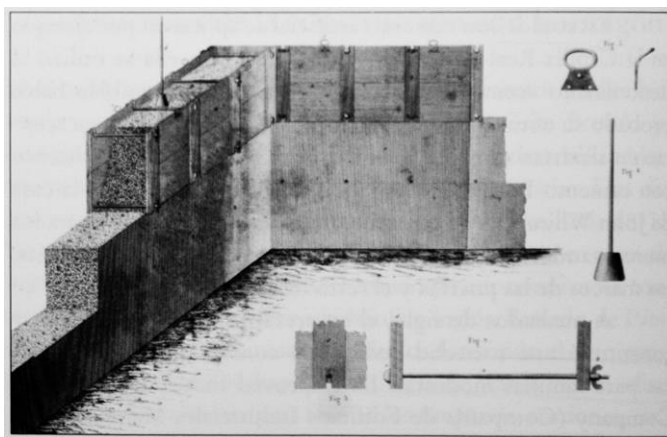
Sistema de construcción de muros de hormigón. (Lebrun, 1835)
